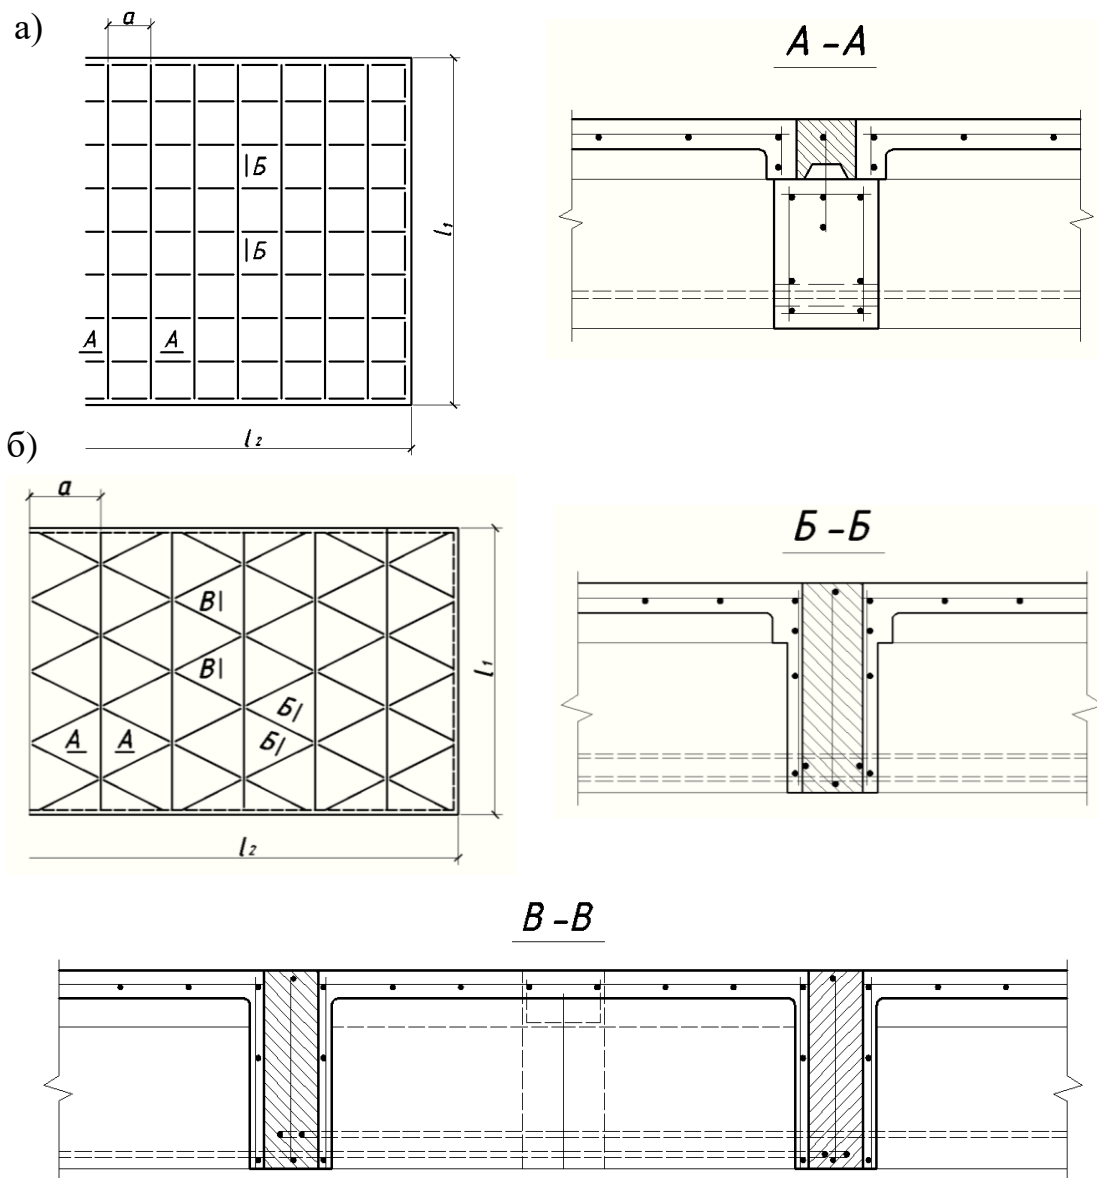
Збірно-монолітні кесонні перекриття:
